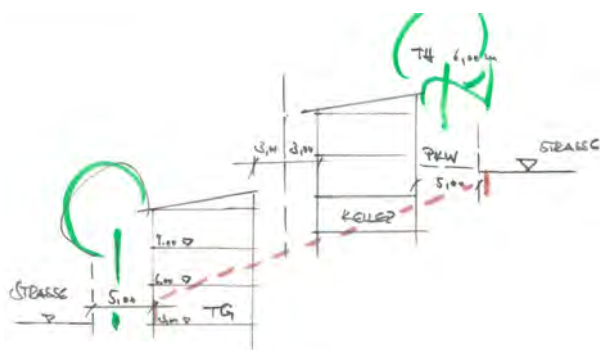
Beispiel Schnitt 3 Geschosswohnungsbau,
